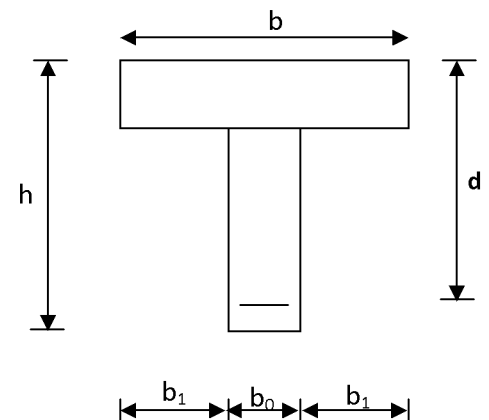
Section de calcul de la poutrelle après Coulage de la dalle de compression
